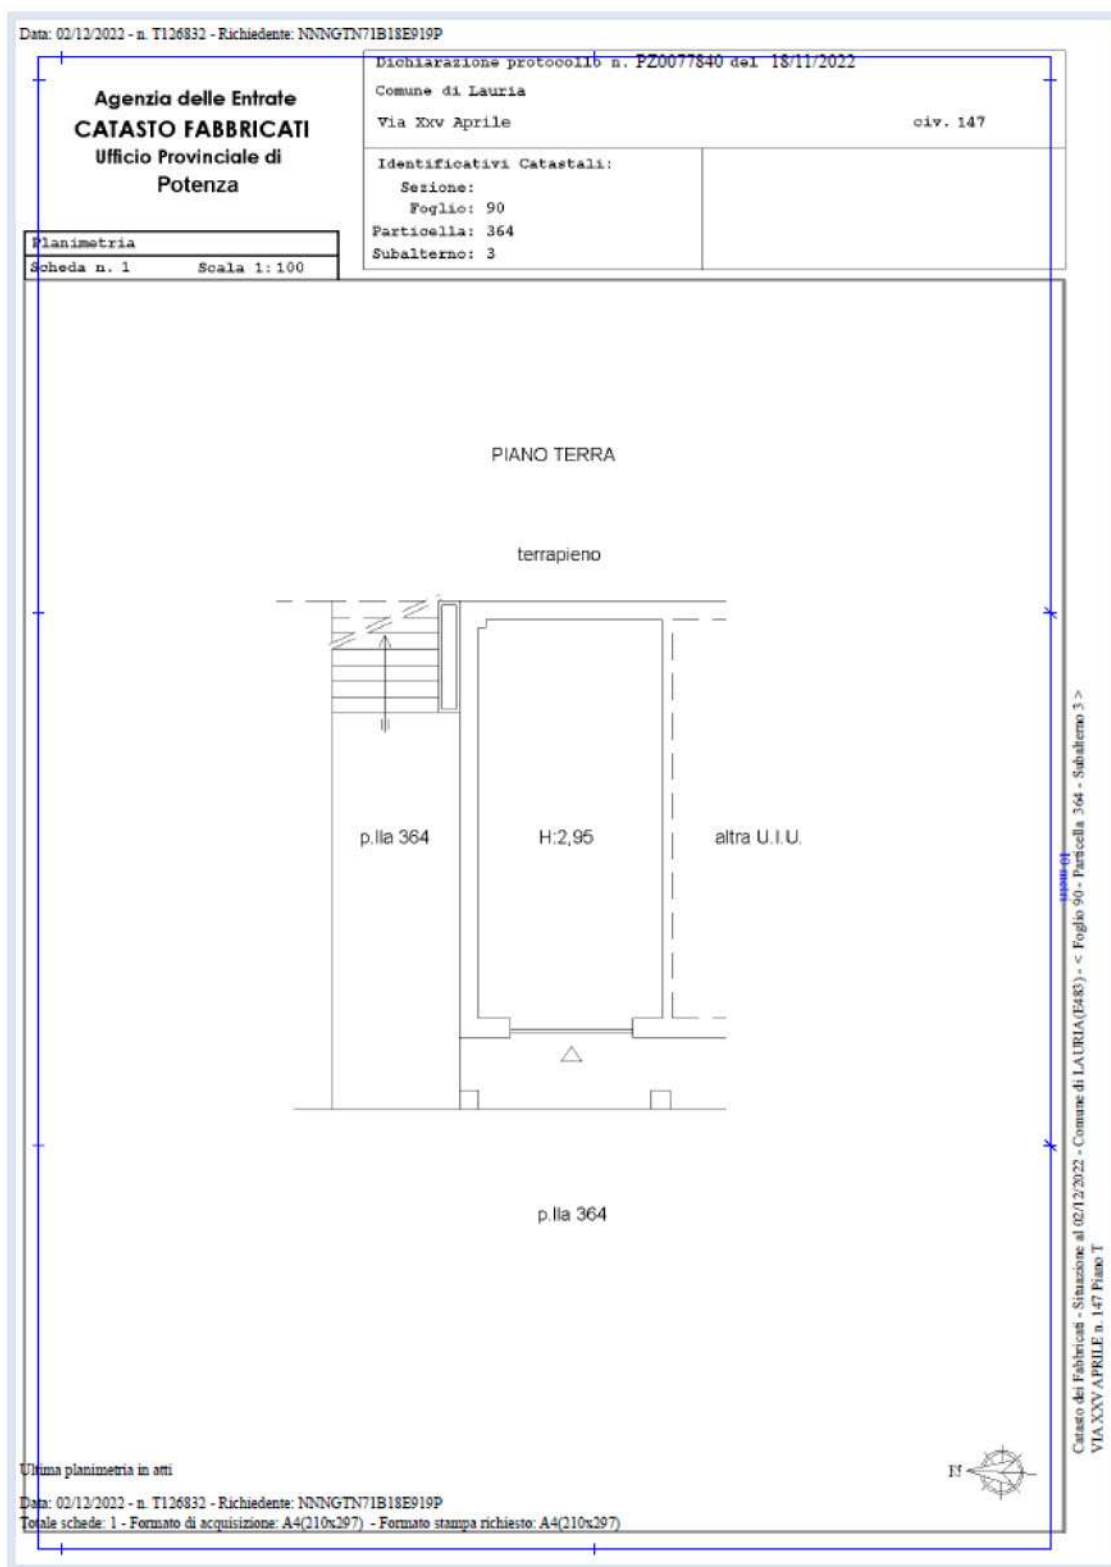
Planimetria “aggiornata” Unità Fg. 90 P.lla 364 sub. 3
